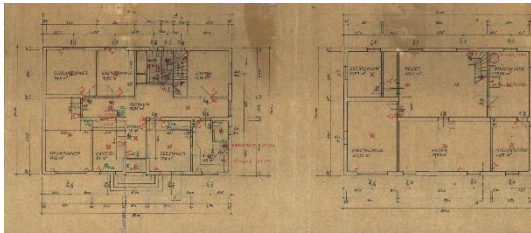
Grundrisse EG und Keller, Pfarrhaus Großhöflein.
